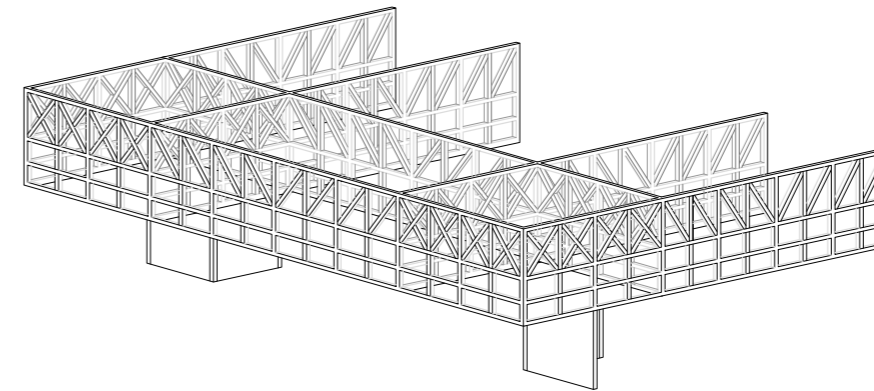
Esquema do sistema construtivo do primeiro piso.
